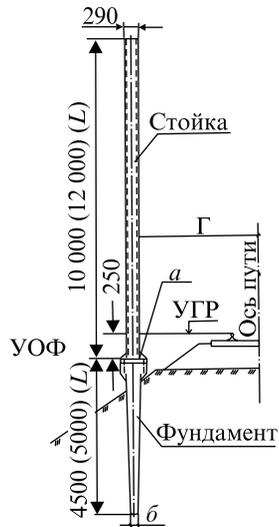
Общий вид железобетонной консольной опоры контактной сети (стойки) ССА на фундаменте ФКА
